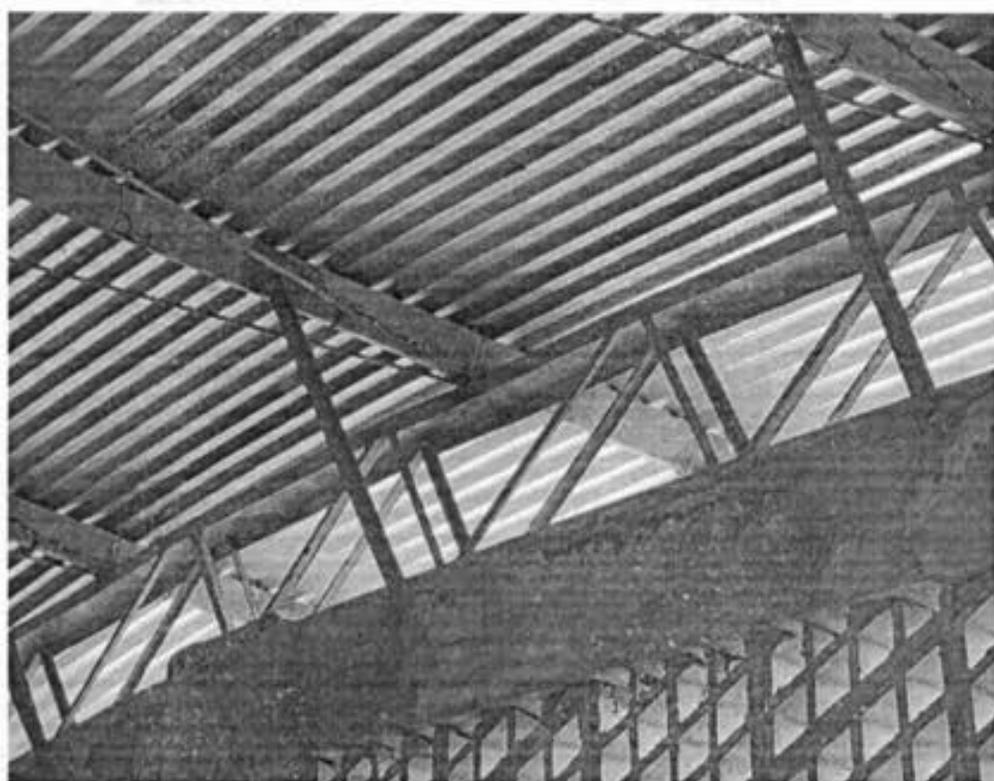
Quadra - Estrutura metálica apresenta coloração não especificada
